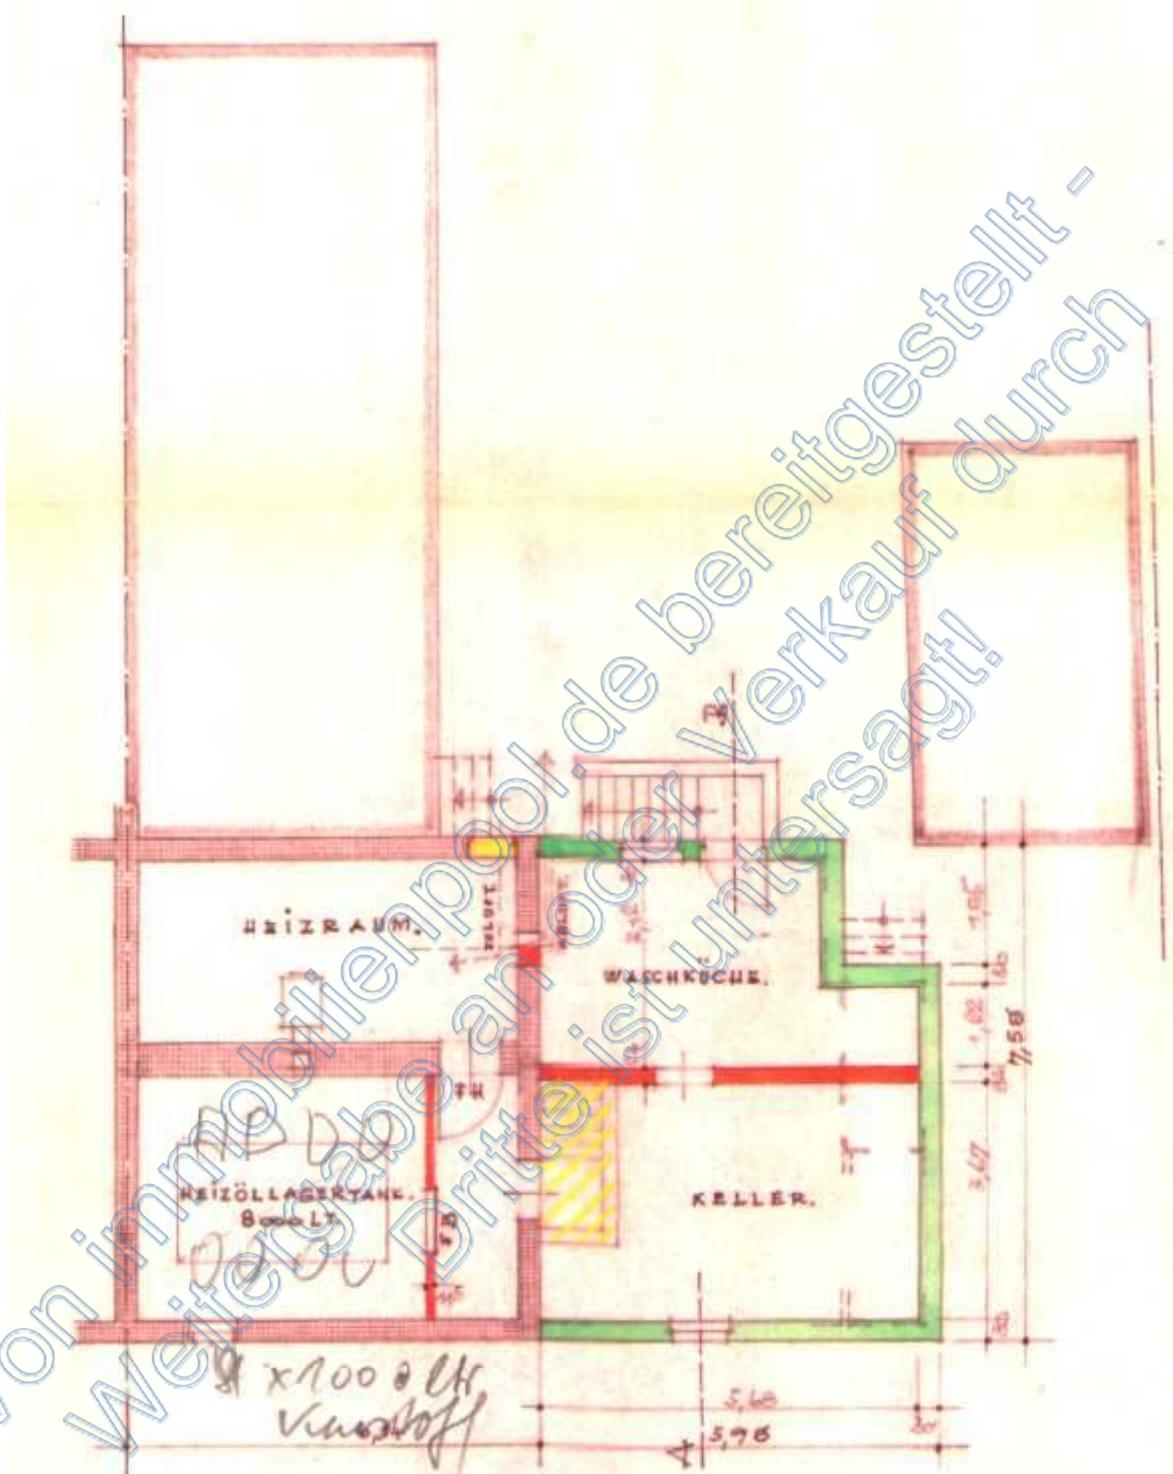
Grundrissplan Kellergeschoss (Vorderhaus), aus Bauakte 1970
